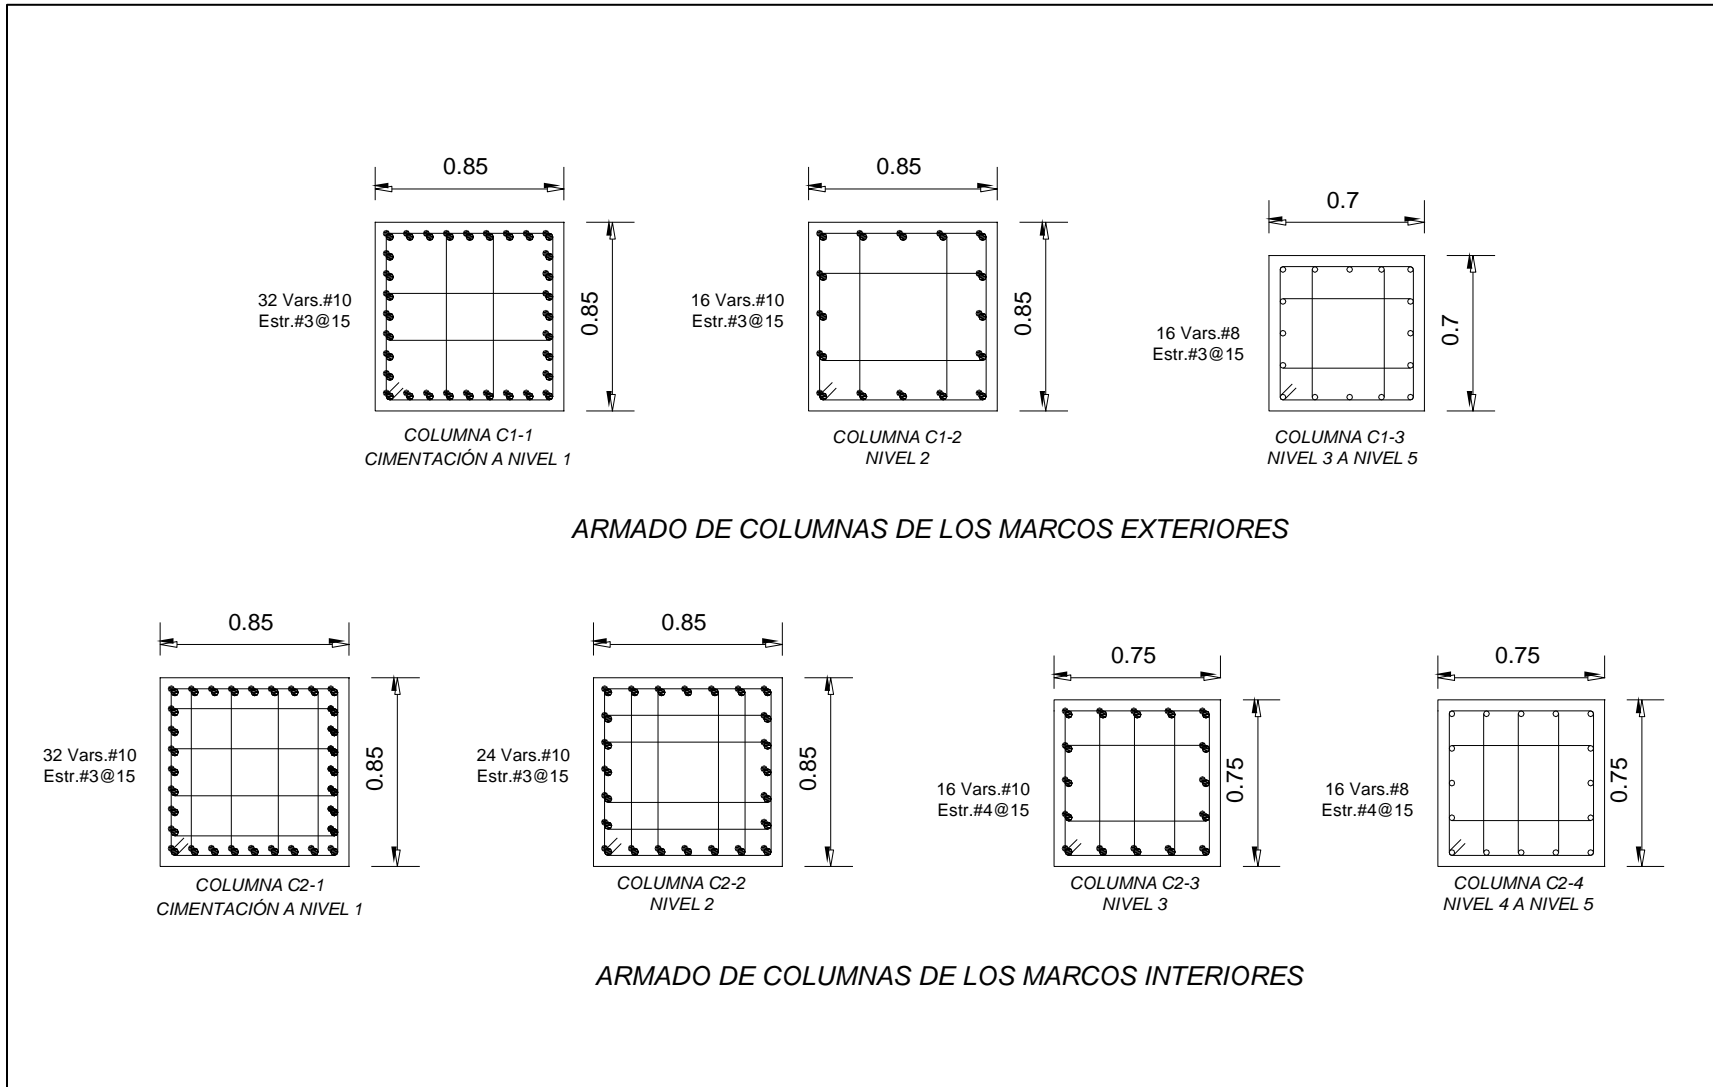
Detalles estructurales del edificio de 5 niveles diseñado con el ACI318-08
